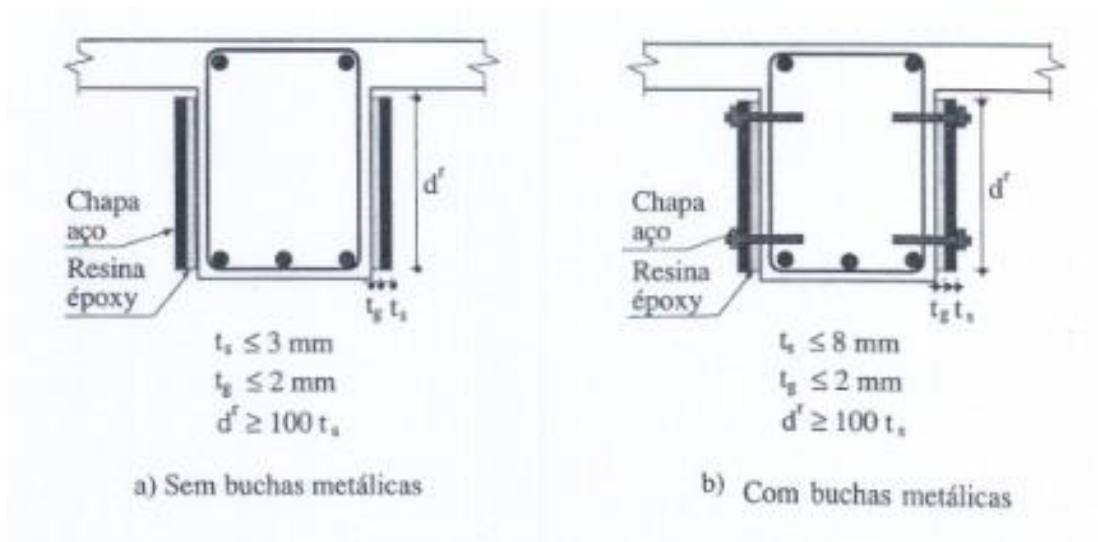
Dimensões recomendadas no reforço ao esforço transversal de uma viga em betão armado. (Gomes, A., Appleton, J.)
